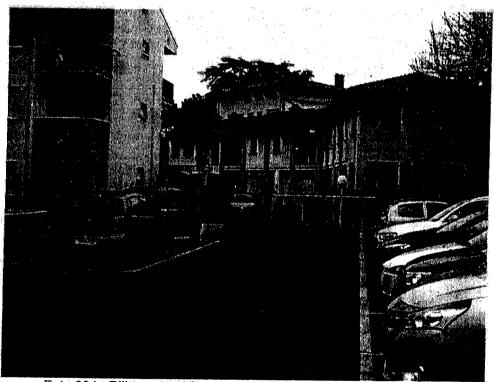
Rilievo autorimesse – Il piazzale interno del condominio.
